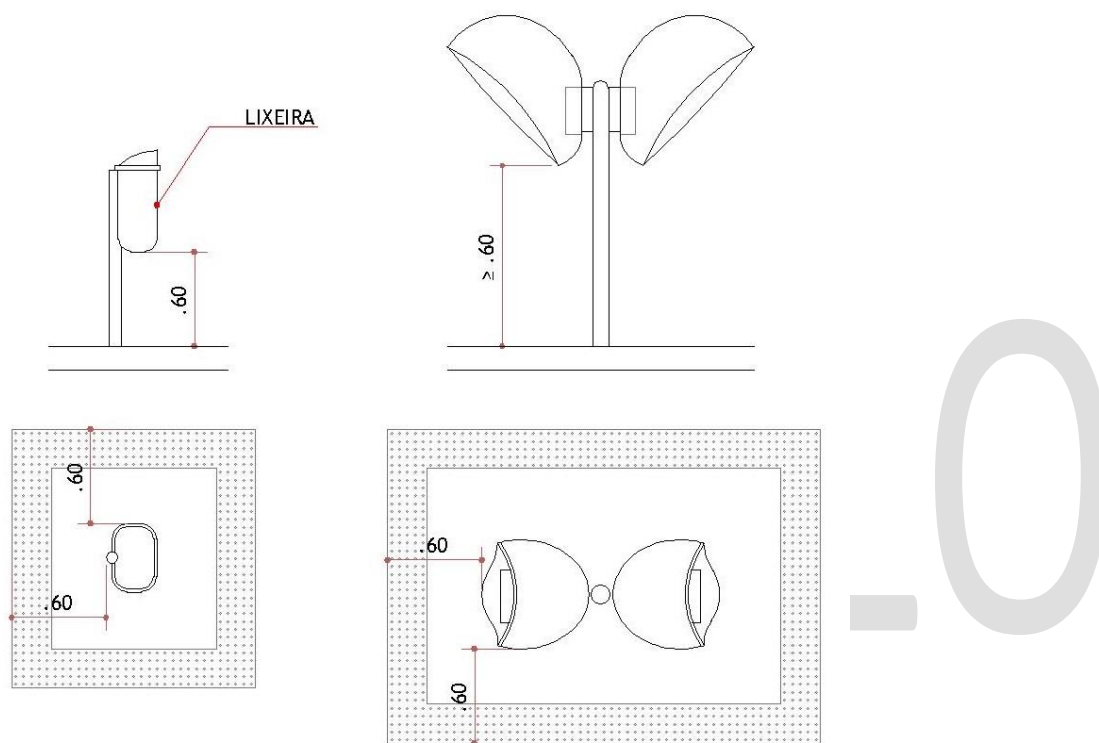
sinalização tátil de obstáculos suspensos, planta e elevação.
